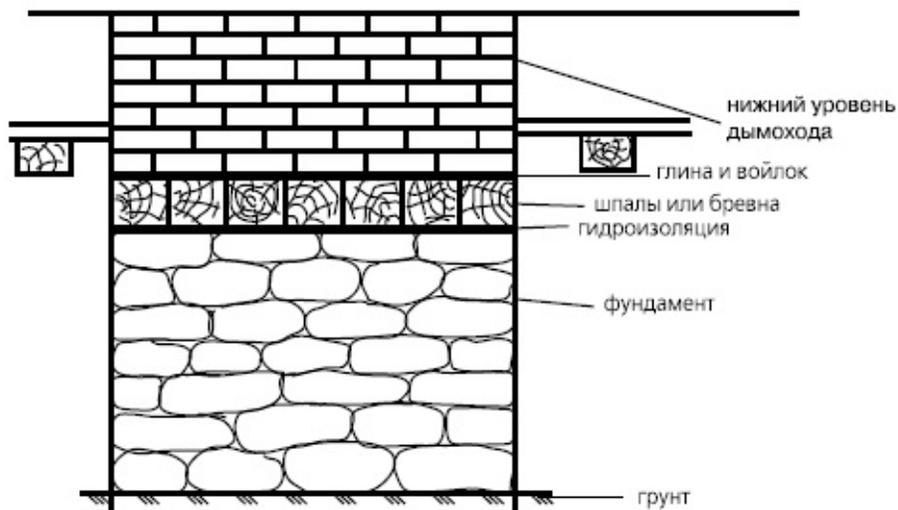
Способ возведения фундамента с теплоизоляцией
